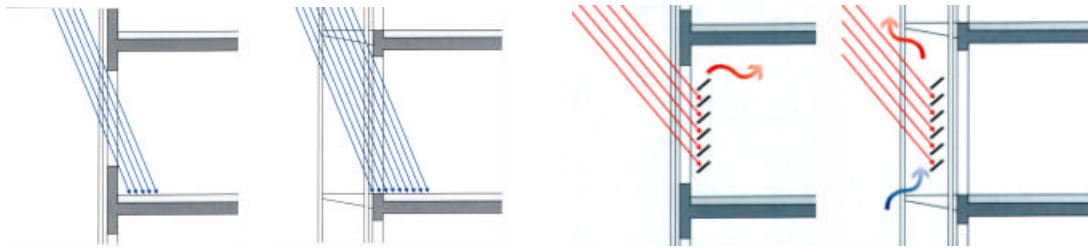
Vergleichende Darstellung des Lichteintritts (links) und der absorbierten Strahlung (rechts) von einer konventionellen Fassade und einer Zweiten Haut Fassade, Quelle: *Zweite Haut Fassade* S. 5
